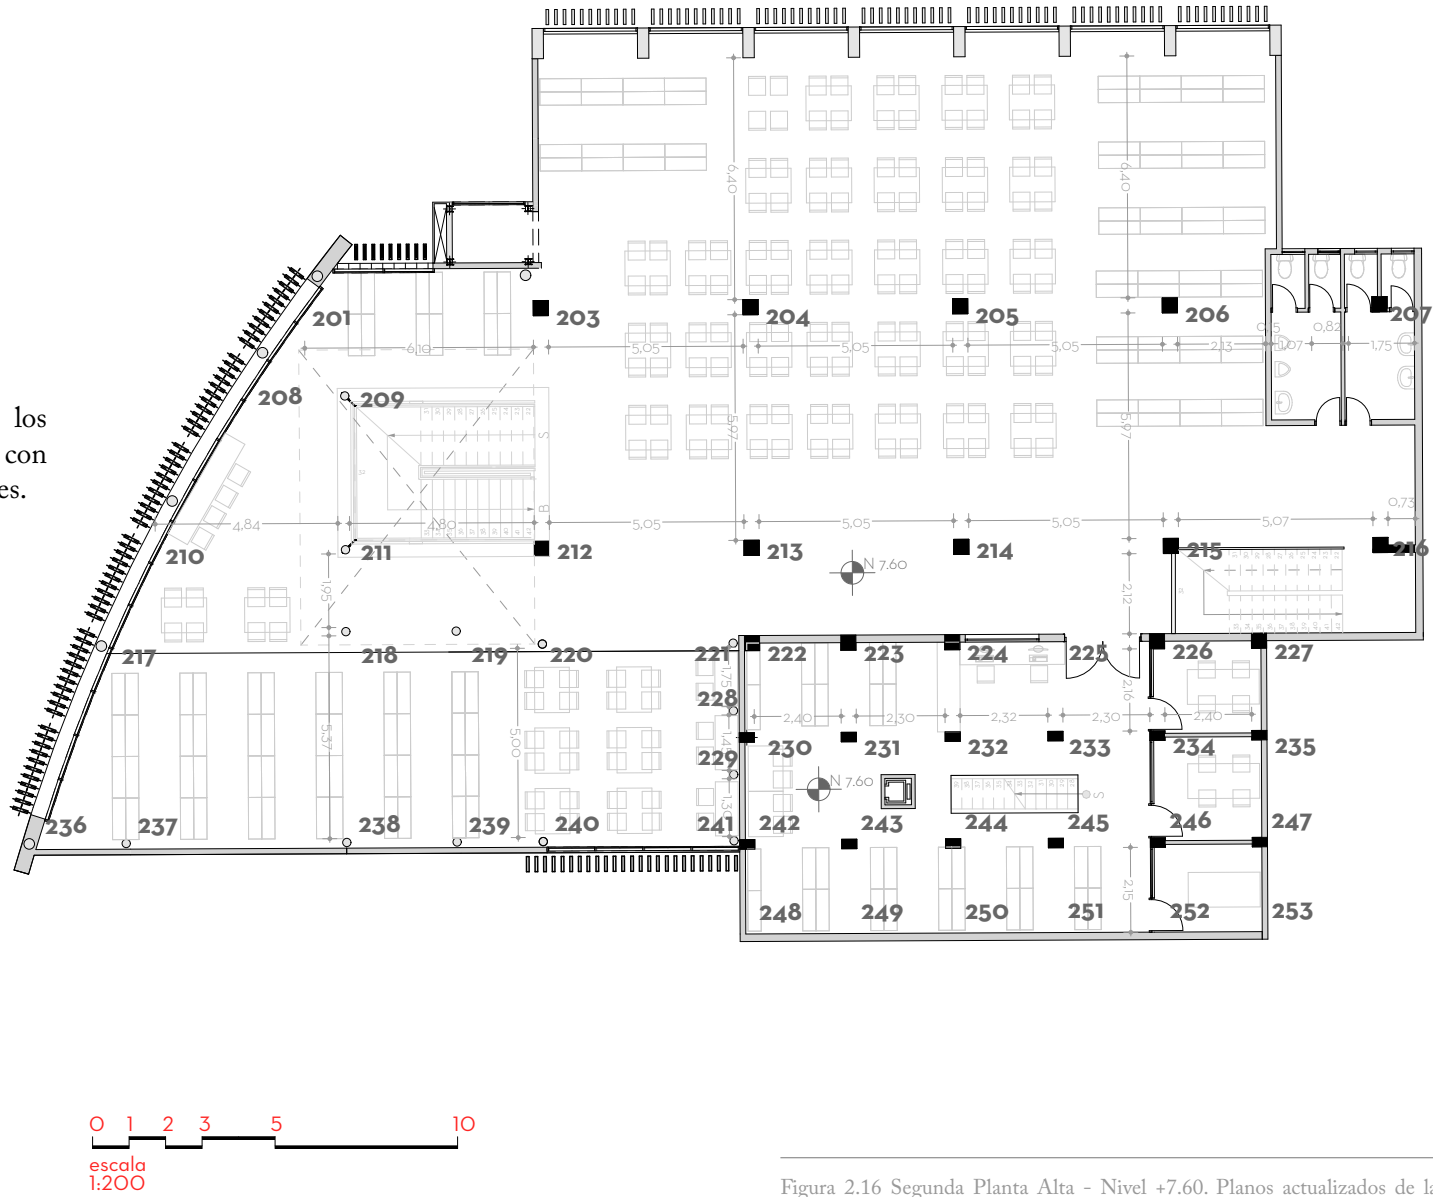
Segunda Planta Alta - Nivel +7.60. Planos actualizados de la edificación del Centro de Documentación Regional Juan Bautista Vásquez. Levantamiento arquitectónico y digitalización realizada por Morocho & Sarmiento (2020).
